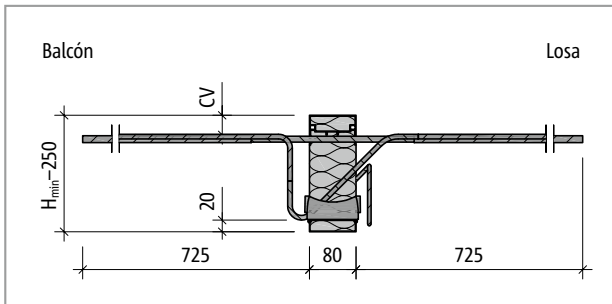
Schöck Isokorb® T tipo K-M7 hasta M11 en R0: Sección del producto
